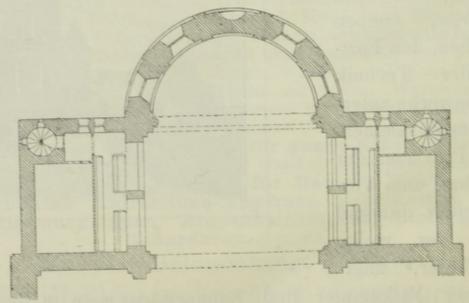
Grundriss in der Höhe der Oratorien
